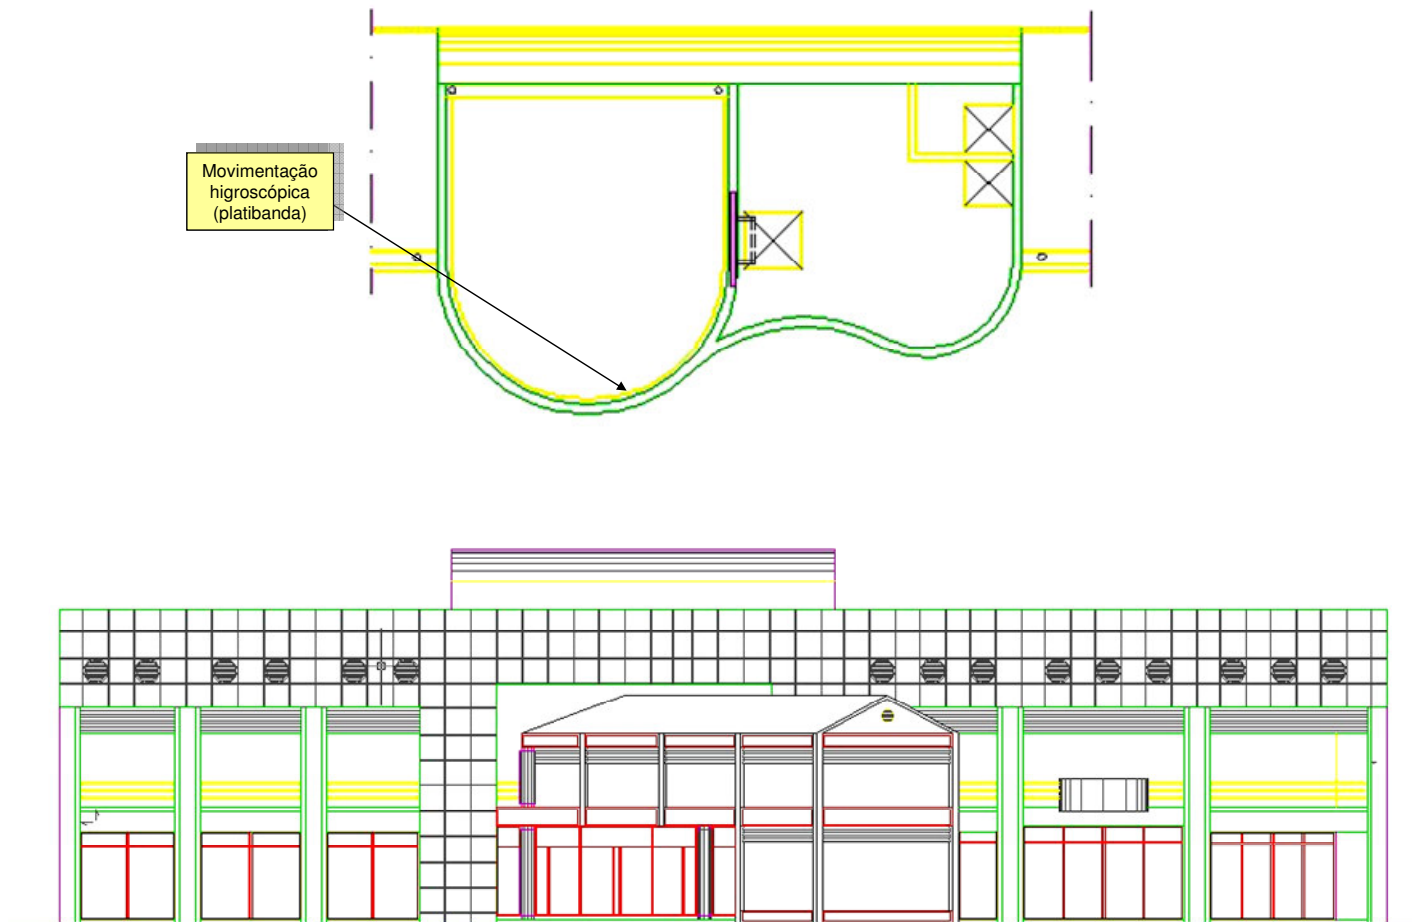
Fachada e Detalhe da Cobertura da escada.
